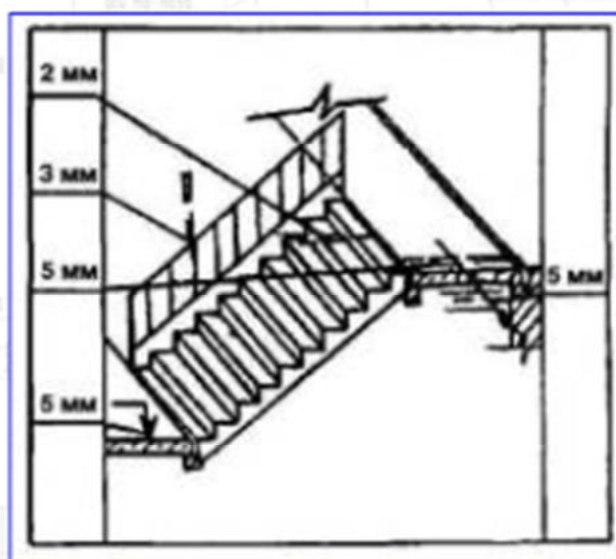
Предельные отклонения при монтаже лестничных маршей и площадок
